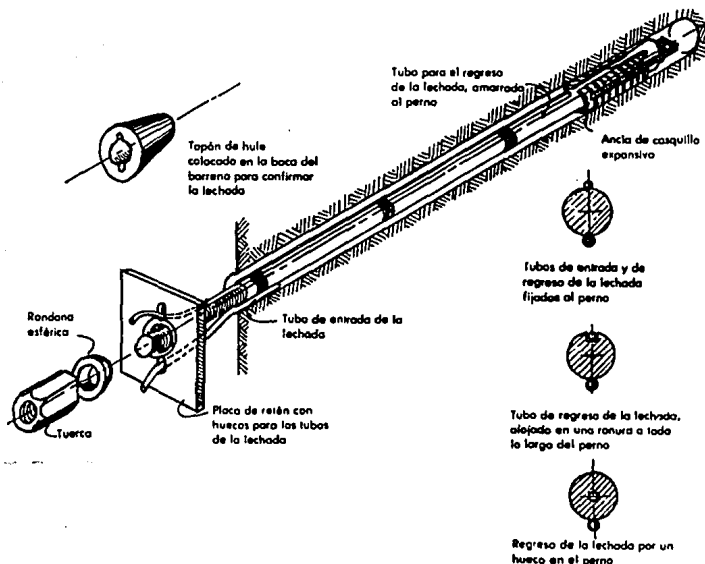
Ancla fijada, tensada e inyectada mecánicamente.
